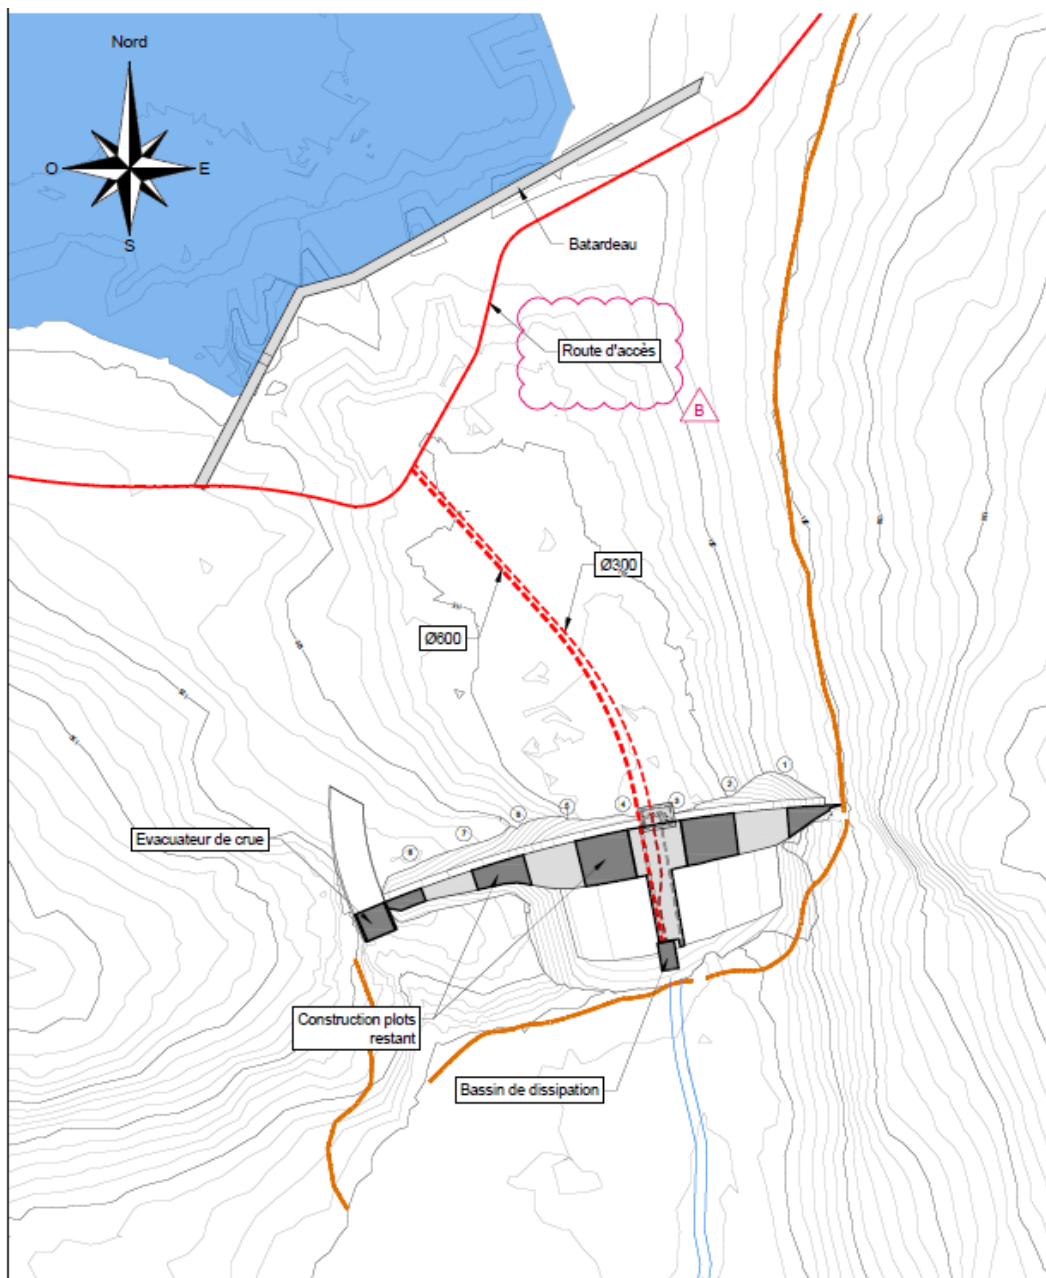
Phase 2 – construction des derniers plots béton, dérivation provisoire par buses et conduites traversant le barrage
